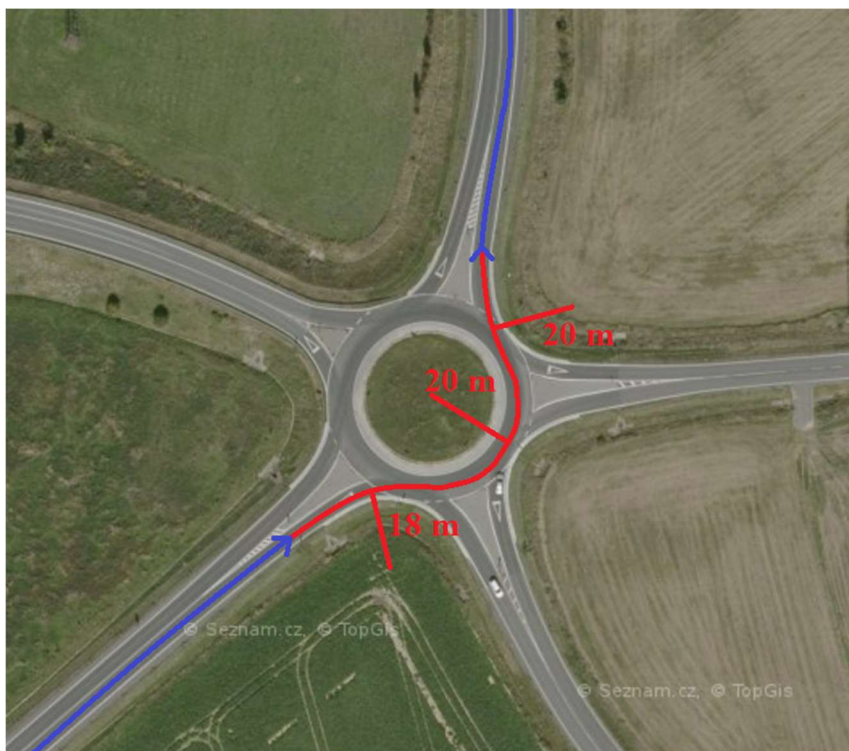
Kritické místo K3 dovoz vrtné soupravy [2]
